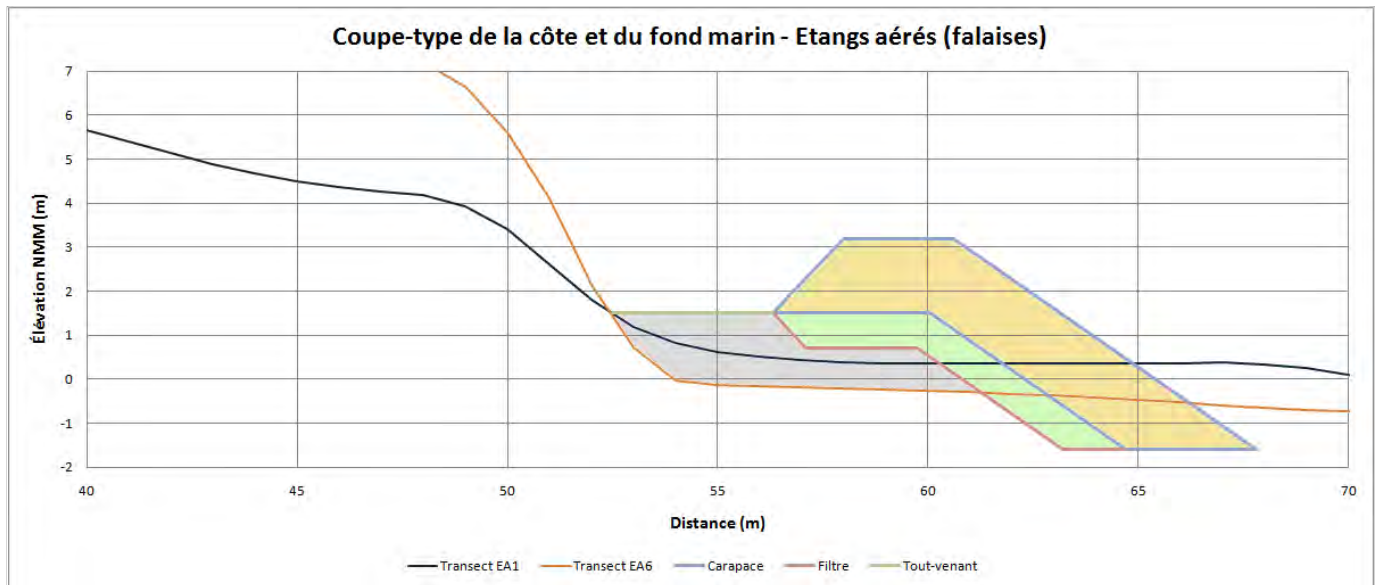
Coupe type d'un enrochement de protection de part et d'autre des étangs aérés
